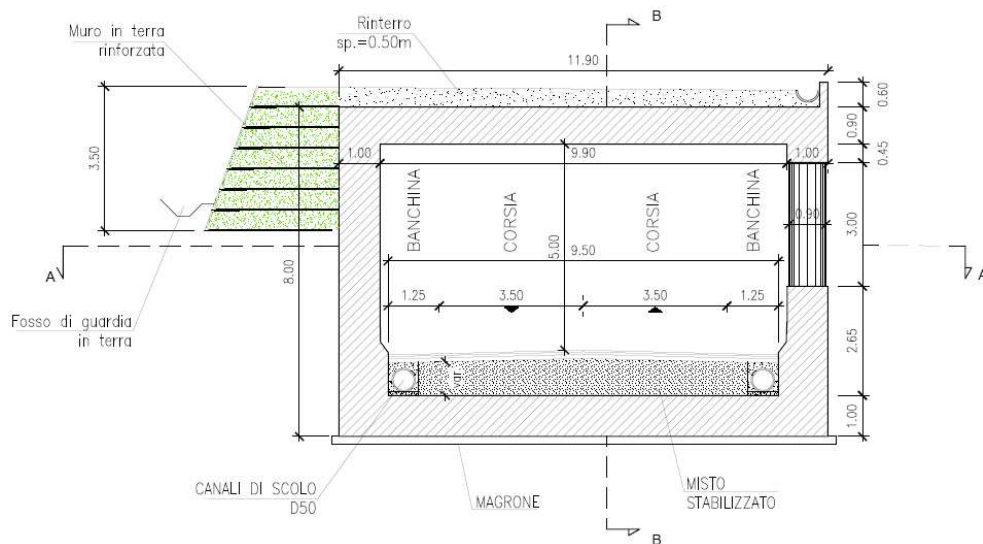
sezione trasversale tipo galleria sfinestrata da 8m
